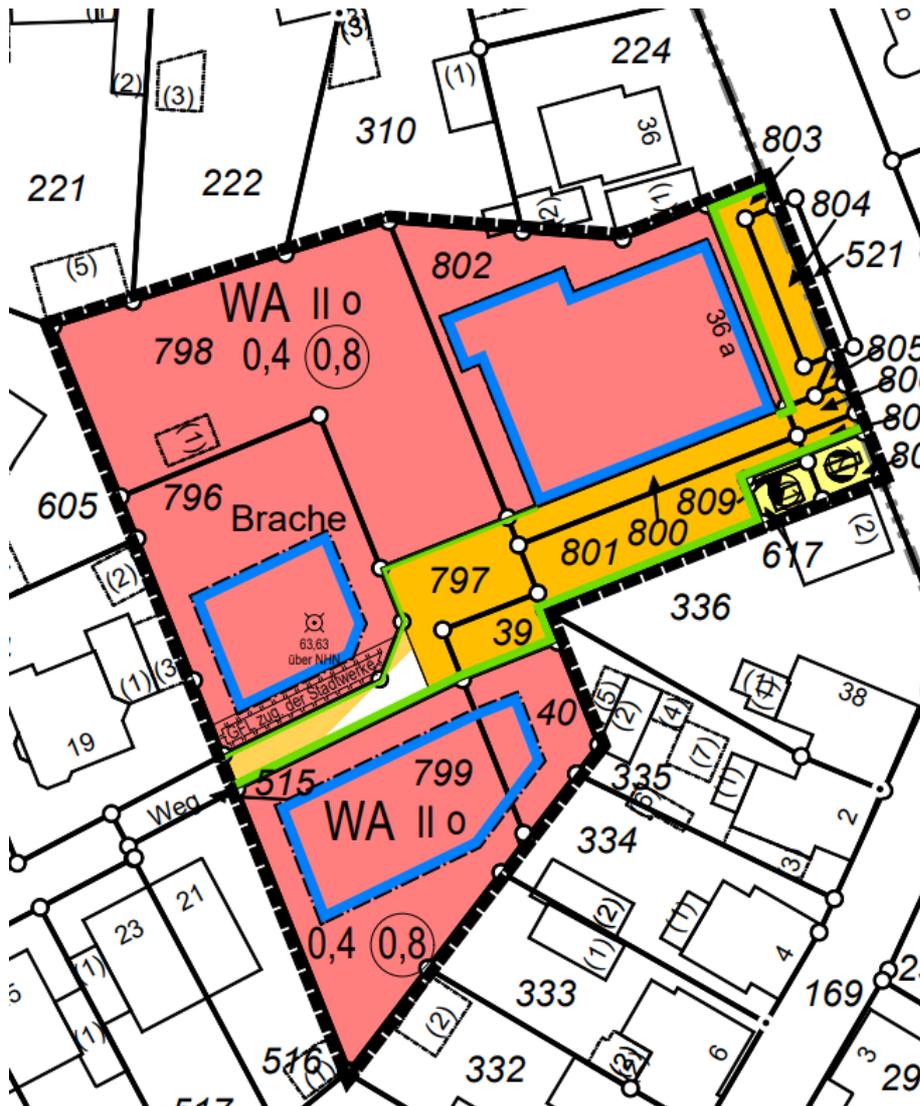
Planzeichnung der 2. (vereinfachten) Änderung des B-Planes Nr. 06.066 – Dahlhof -
